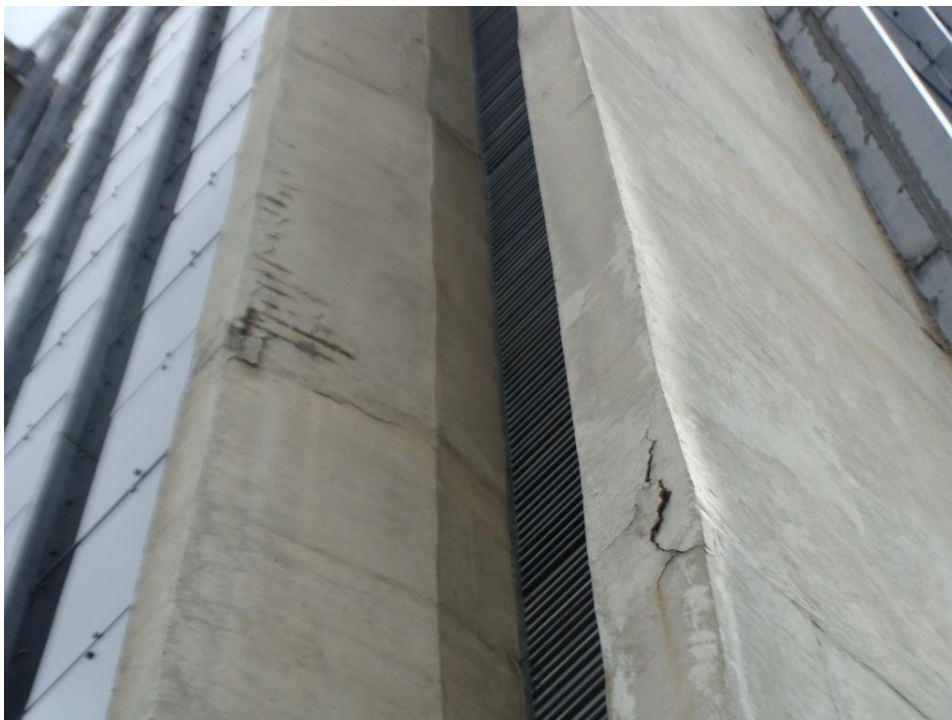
Armadura exposta pilar P14 (2º pavimento) (02/03/2021)
